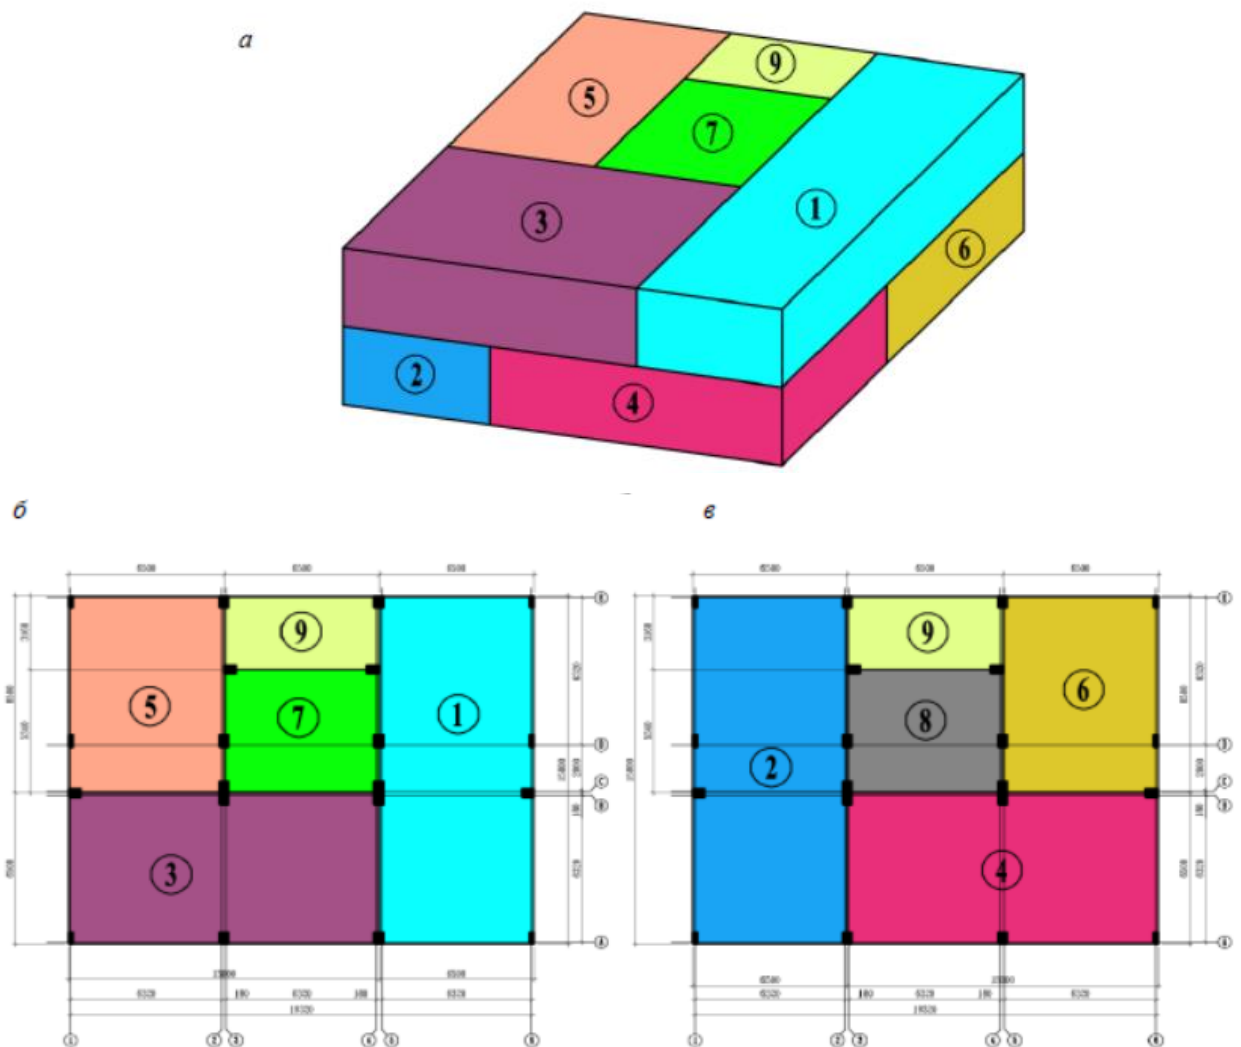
Приклад схеми збирання будівлі із блоків: а – просторова схема збирання блоків; б – план верхнього поверху; в – план нижнього поверху; 1-6 – основний модуль; 7-8 – модуль МОП (місце громадського користування); 9 – двохповерховий модуль ЕСВ (евакуаційно-сходовий вузол)
